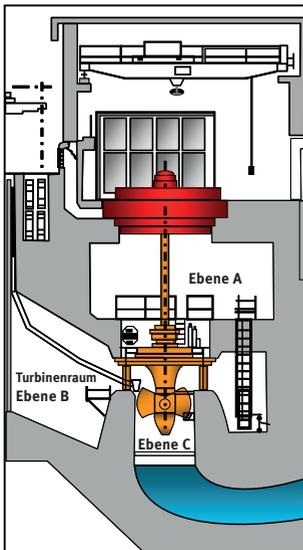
Querschnitt durch ein Maschinenhaus eines Laufwasserkraftwerkes
